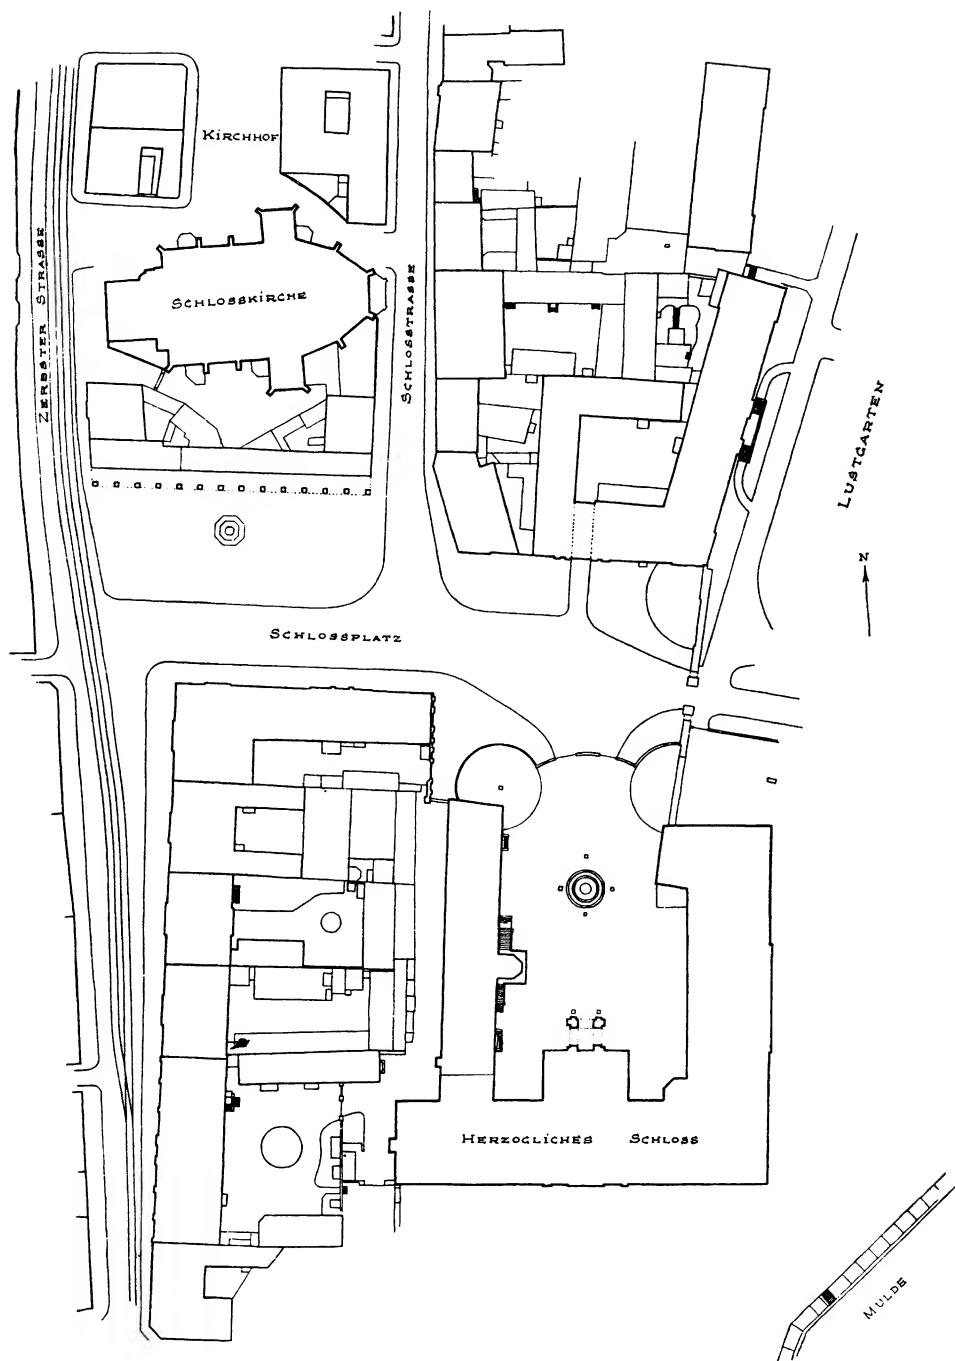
Lageplan der St. Marien- (Schloß-) Kirche und des Schloßes
